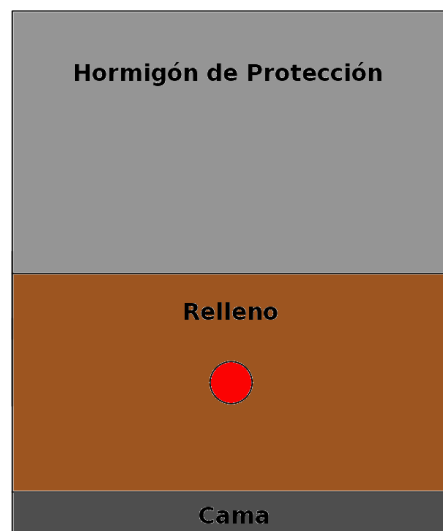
Sección transversal de la zanja para los tubos de reparto de BIE.
